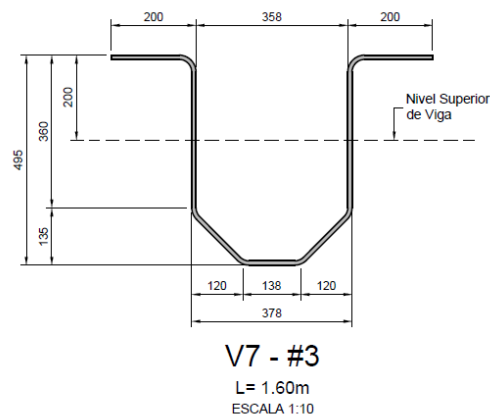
Geometría original de varilla tipo V7 en viga de superestructura n.º 4
